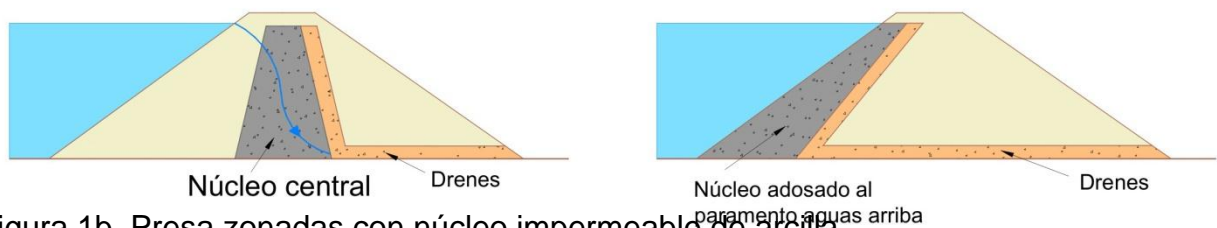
Presa zonadas con núcleo impermeable de arcilla.
